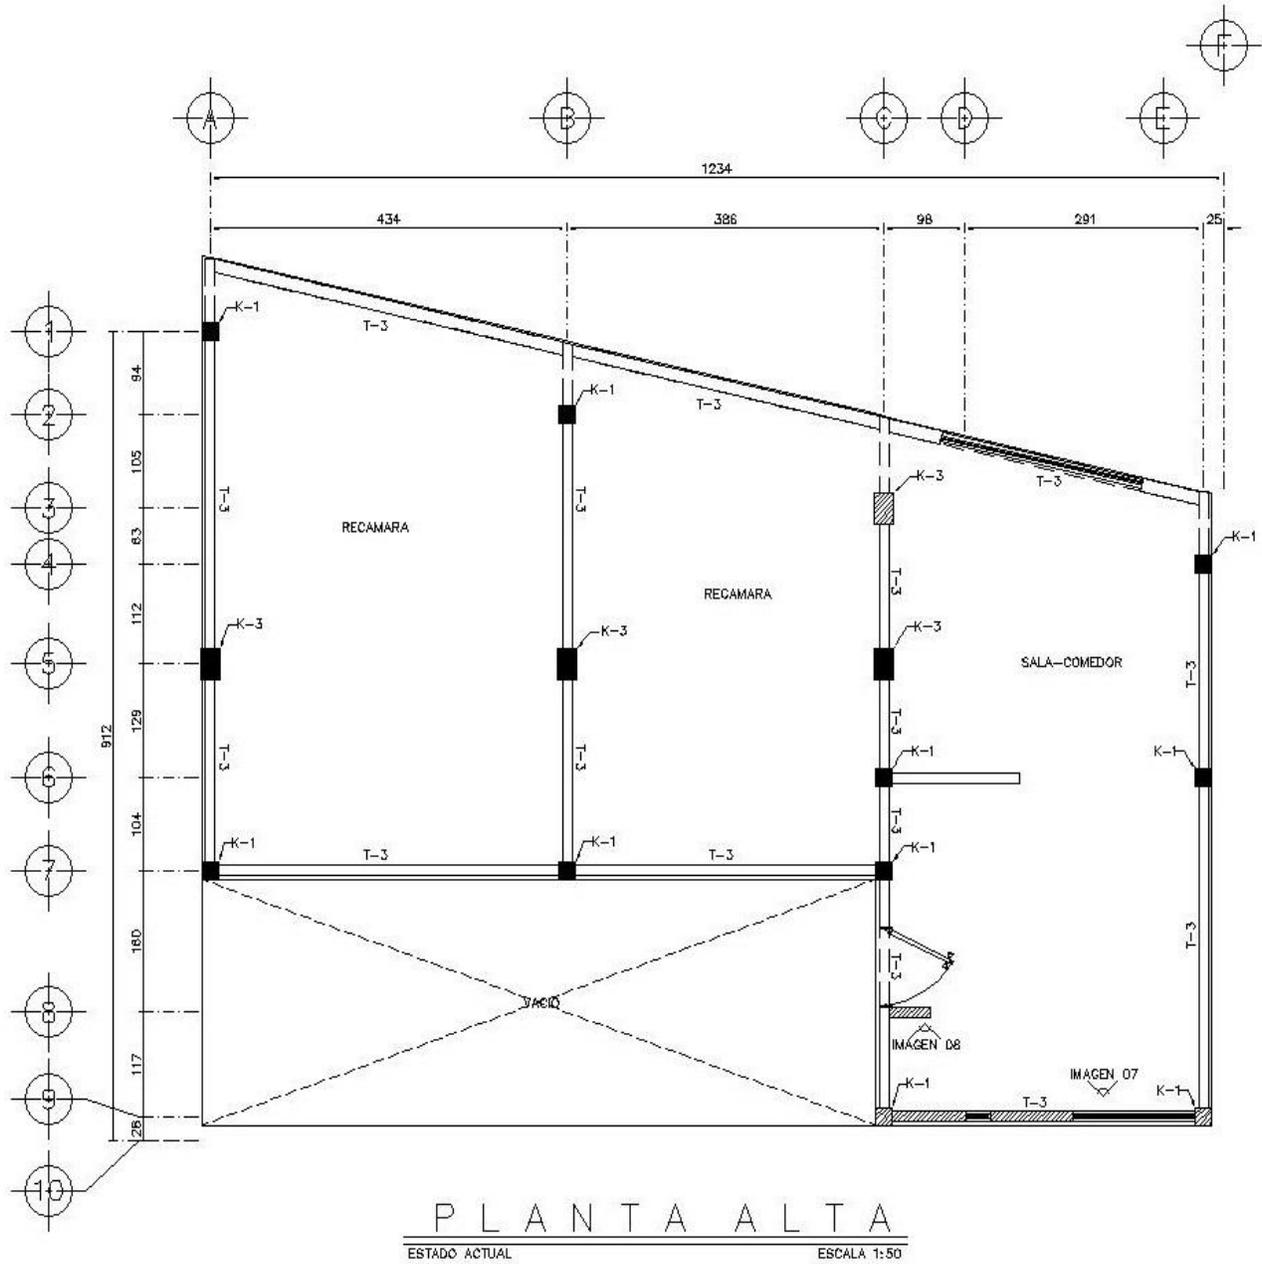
Estado Actual de la vivienda planta alta.
